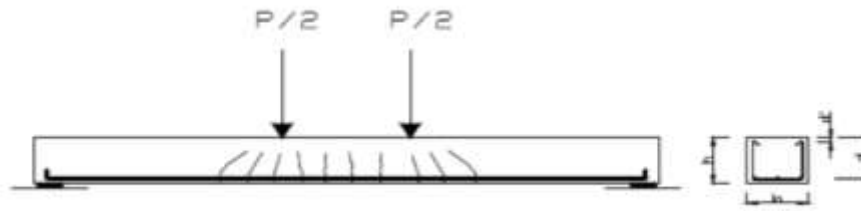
2-. Viga sometida a dos cargas incrementales. (Nonlinear behavior of reinforced concrete structures, Antonio Mari, 2017).
